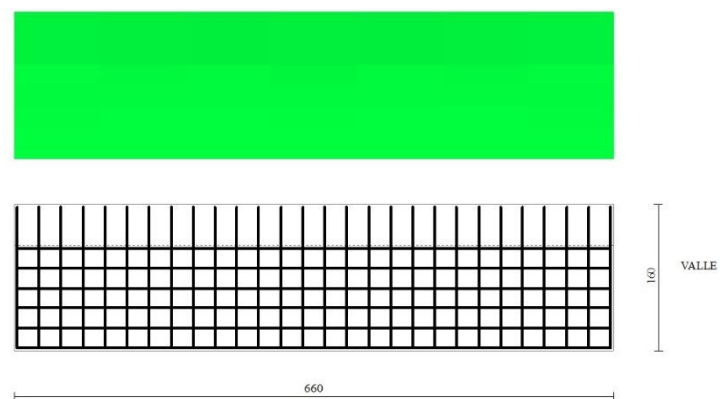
Piastra fondazione dir. Y (Inviluppo)
